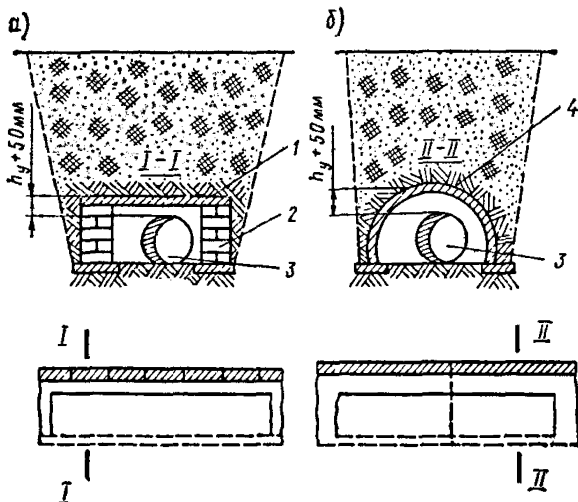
Схемы легких непроходных каналов, исключающих силовое воздействие грунта на трубу
